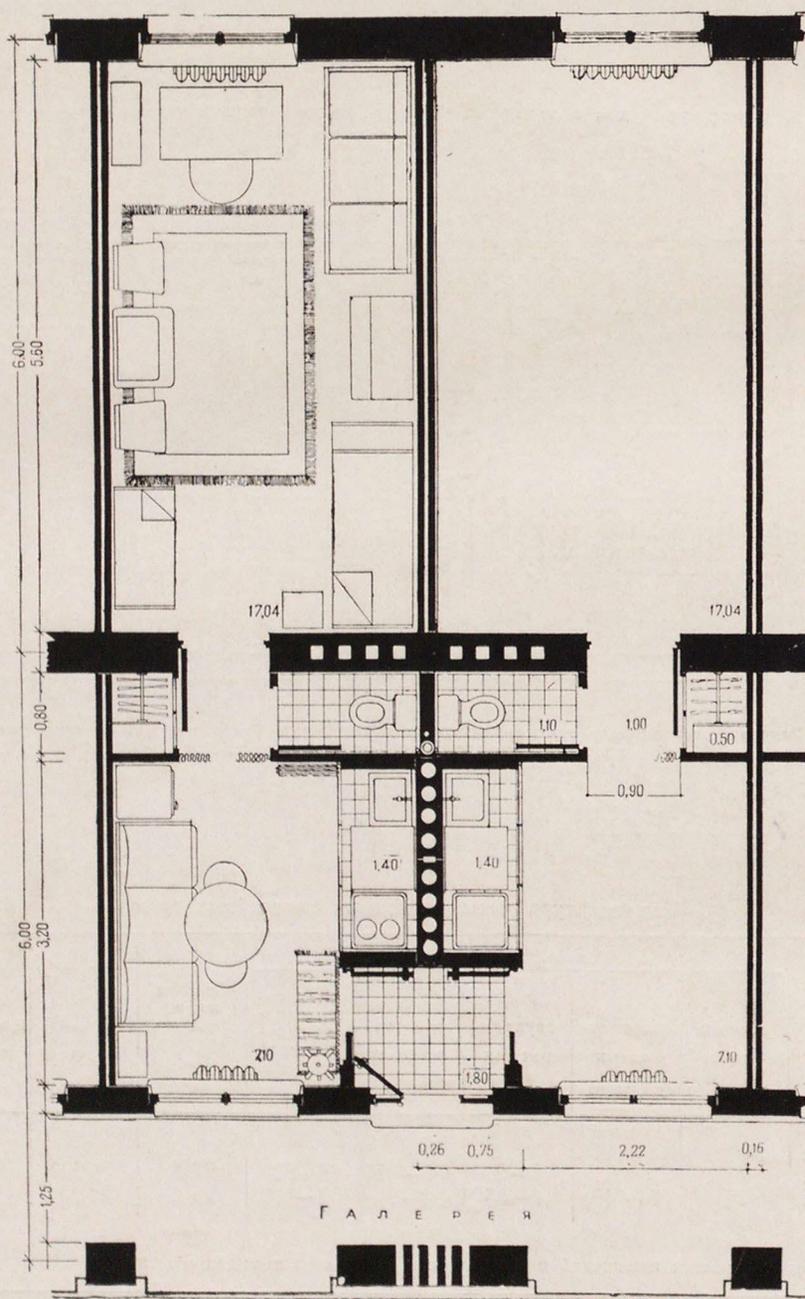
План рядового отсека галерейного дома. Дом состоит из двухкомнатных квартир с кухнями-нишами
